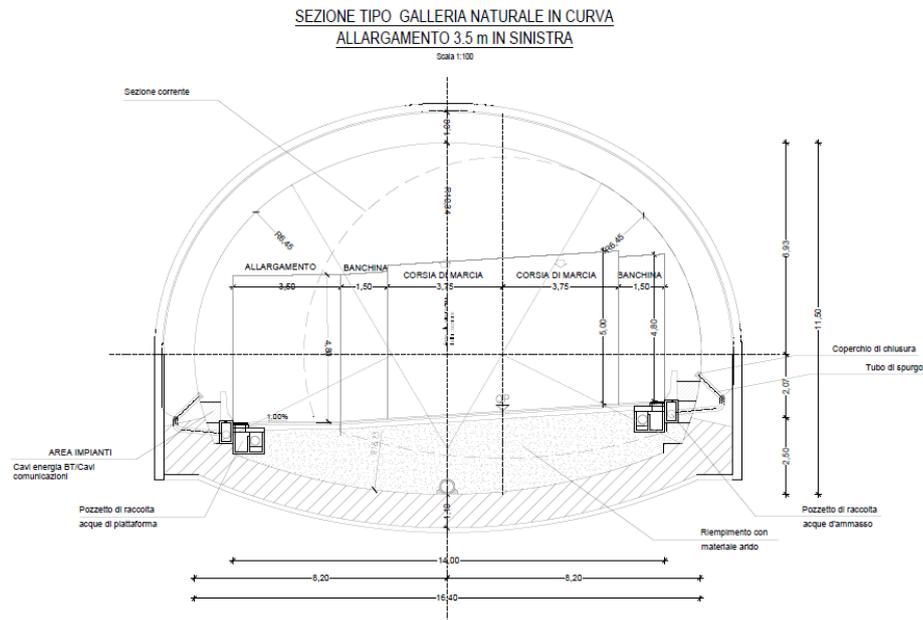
Galleria naturale, sezione tipo allargata 3.5 m.
